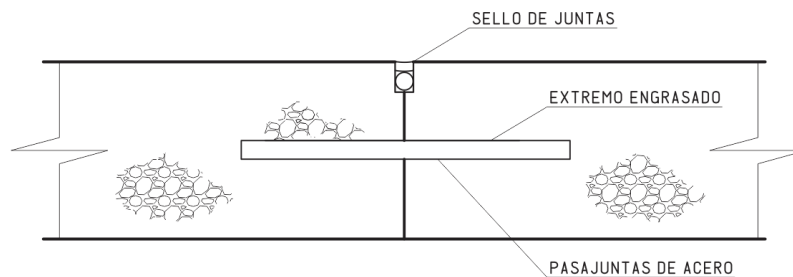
Fundición de pavimento e instalación de refuerzos con varilla lisa #7
